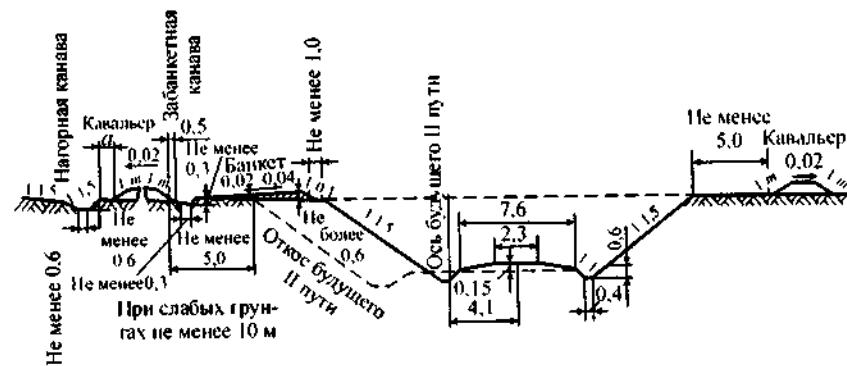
Выемка глубиной до 12 м с шириной основной площадки 7,6 м при поперечном уклоне местности не круче 1:3
